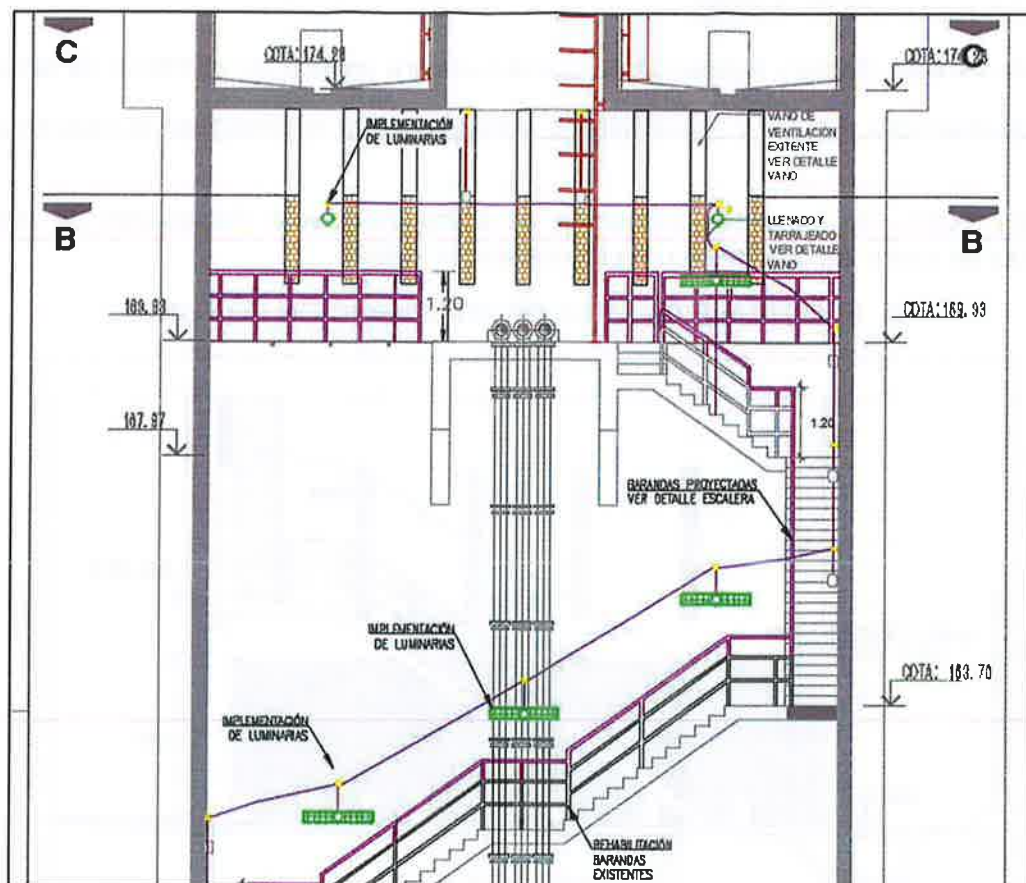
DETALLE DE UBICACIÓN DE BARANDAS PROYECTADAS
